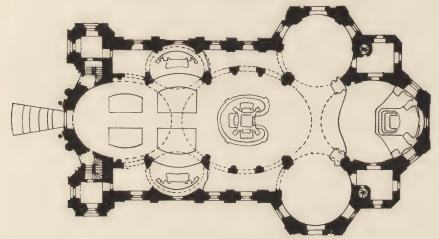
Kirche zu Vierzehnheiligen. Grundriss.
